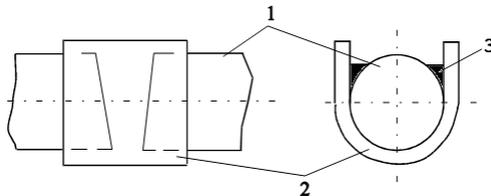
Сборка под ванную сварку горизонтальных стержней арматуры:
